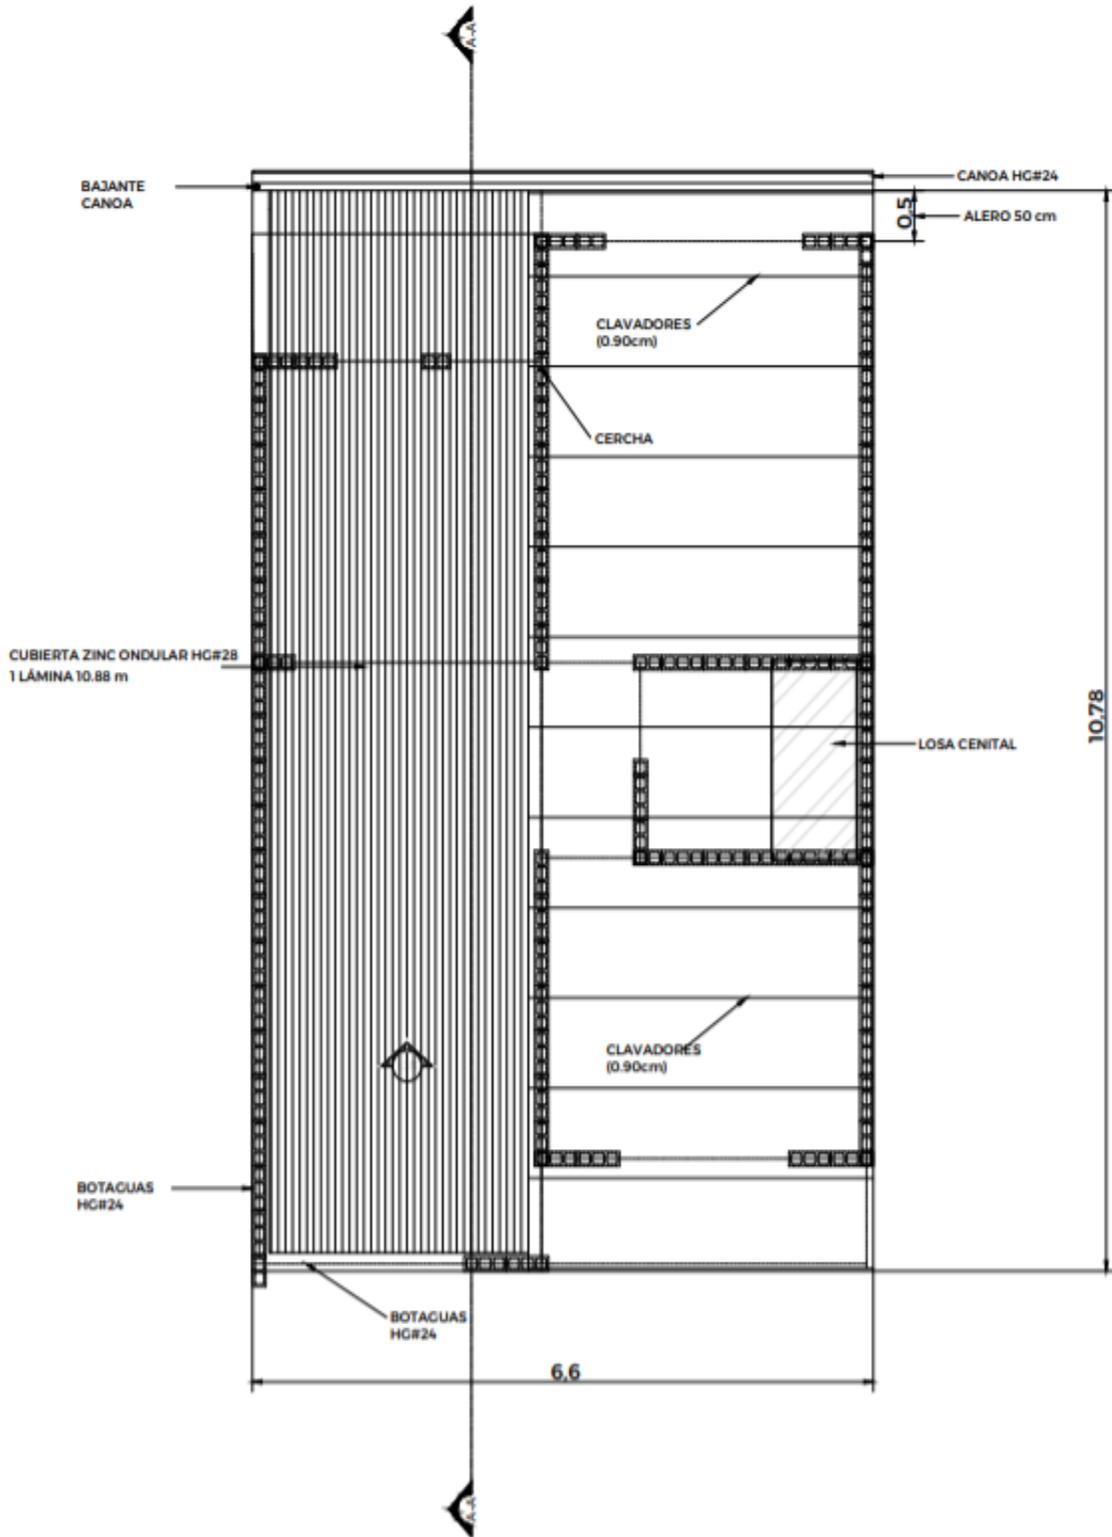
Planta de techos 1 agua - Sistema constructivo Teknoblock- Lamina prefabricada
